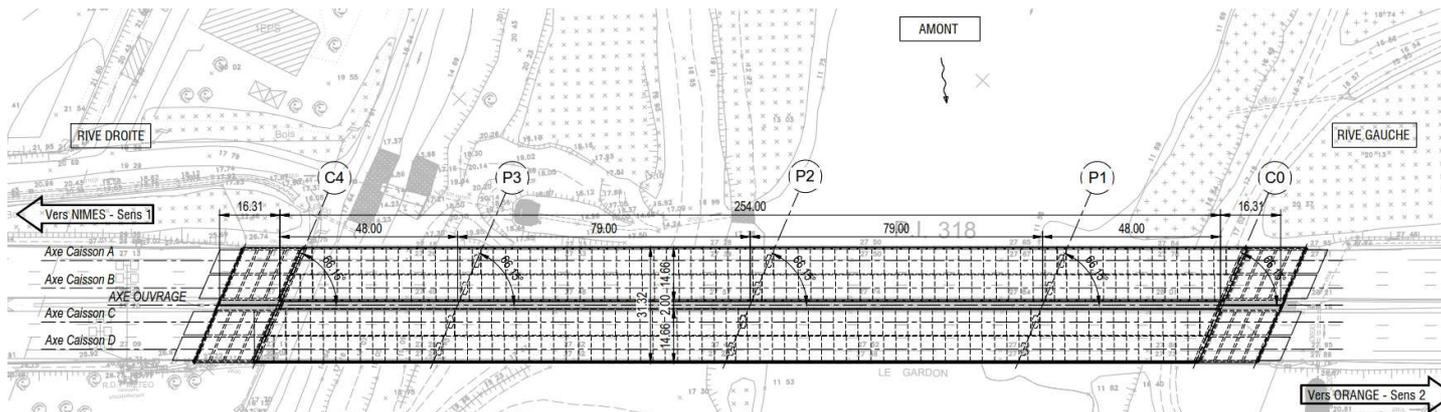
Vue en plan de l'ouvrage (source : Arcadis MOE PRO)
